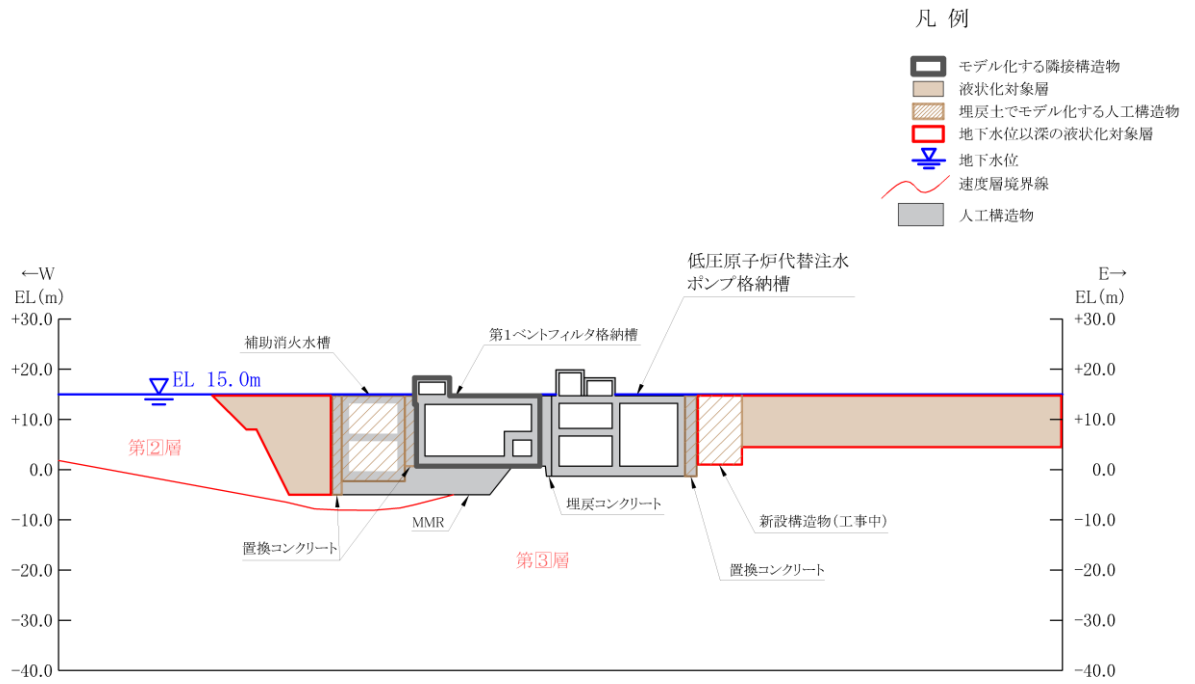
低圧原子炉代替注水ポンプ格納槽 評価対象断面図 (C-C 断面)
